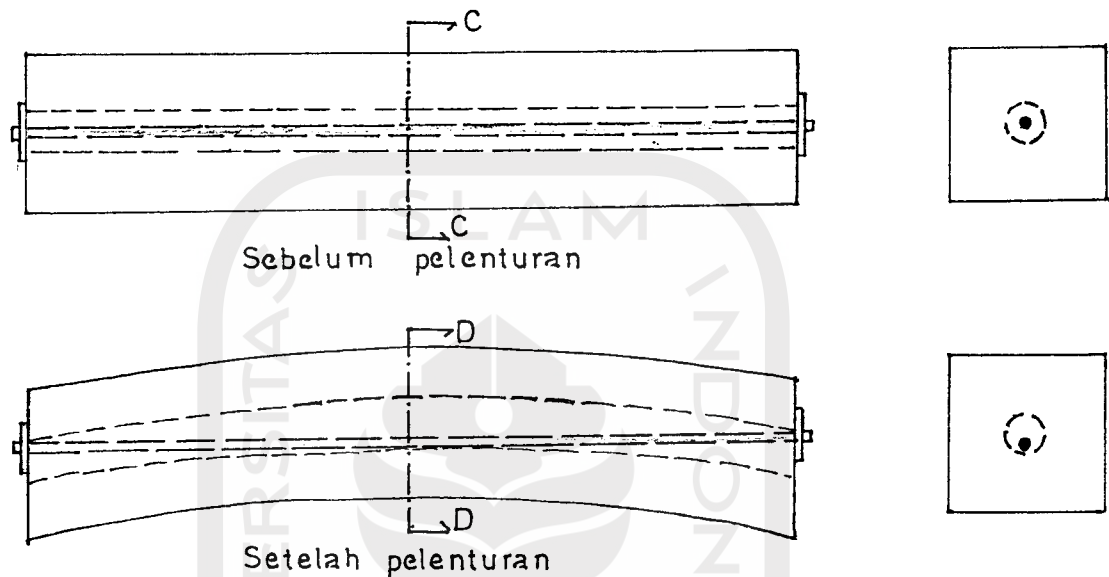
b Aksi pengimbangan dari beton dan baja
